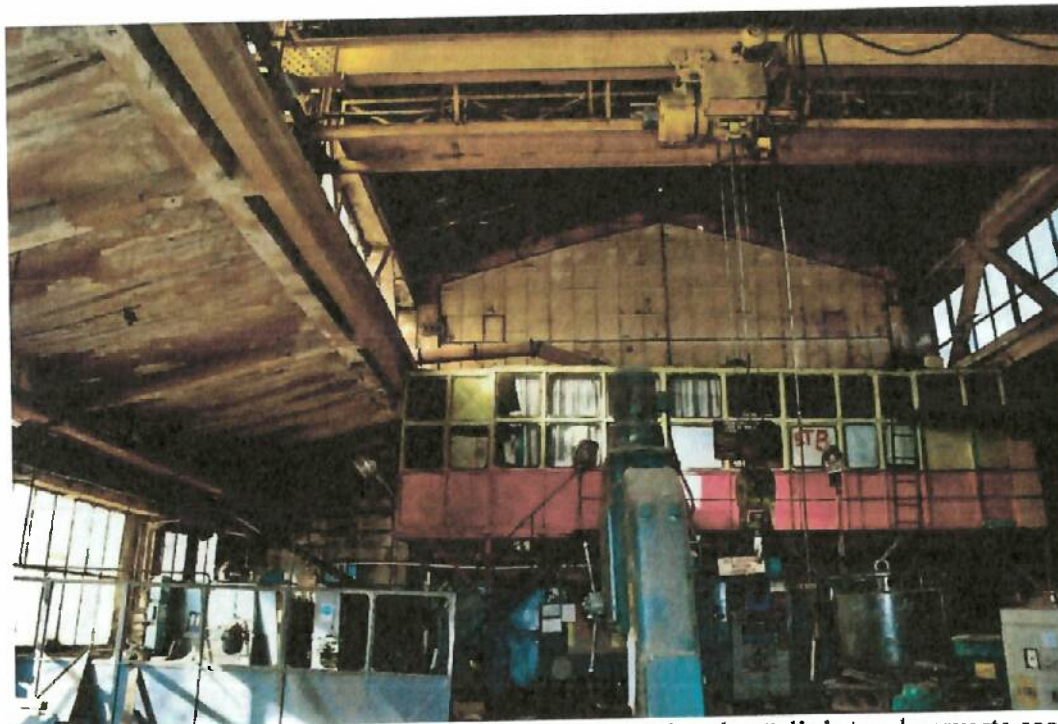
Atelier intretinere 11, Atelier turnatorie (C28): Structura interioară din beton deservește scopul de susținere a utilajelor interioare
